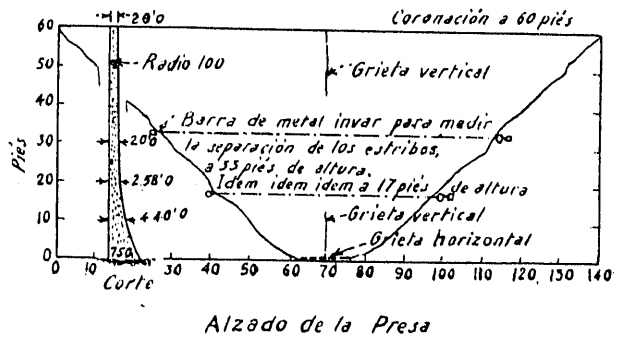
ª Grietas aparecidas en la presa.
